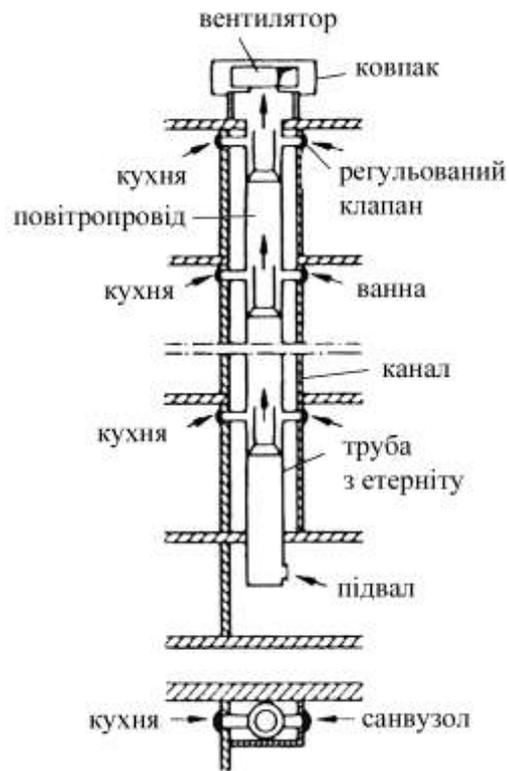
Механічна вентиляція кухонь і ванних кімнат помешкань кількоповерхового житлового будинку з вентилятором на верхівці вертикального збірного трубопроводу із стерніту
